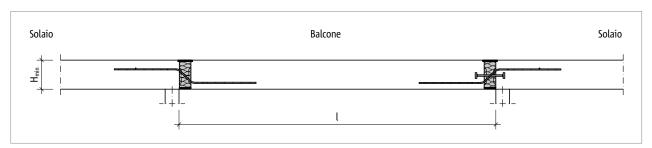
Schöck Isokorb® T tipo QP-Z, QP: sistema statico
